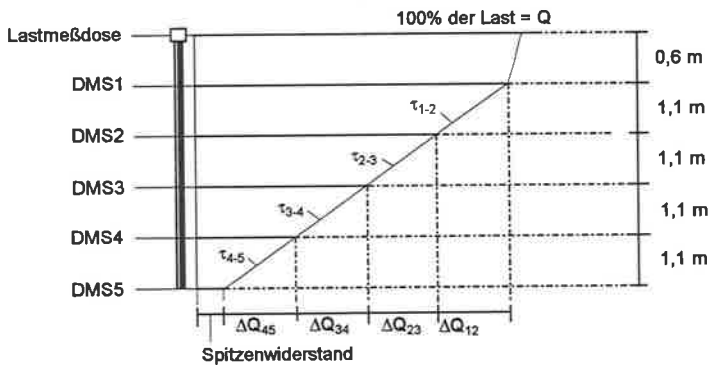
Schema zur Lastabtragung unter statischer Belastung
